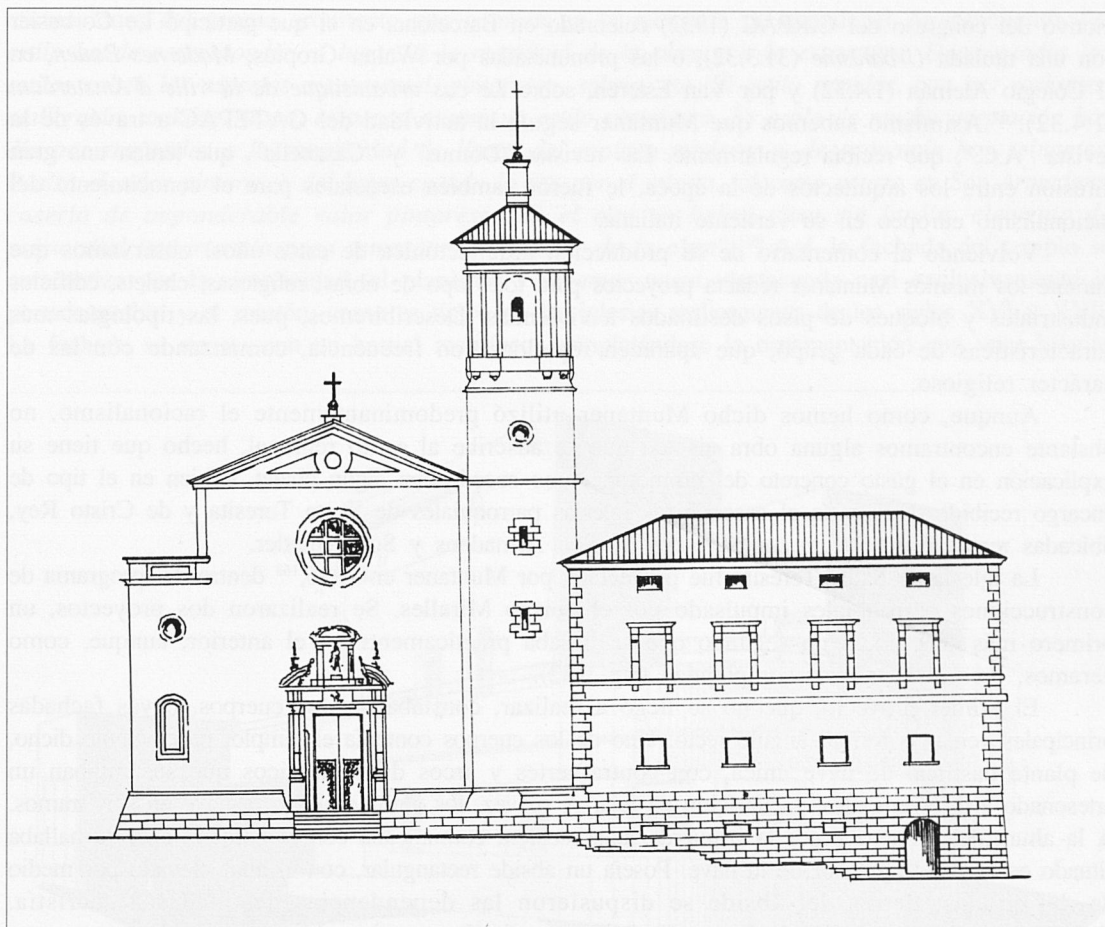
Guillermo Muntaner. Parroquial de Santa Teresita. Proyecto de fachada (1936).
